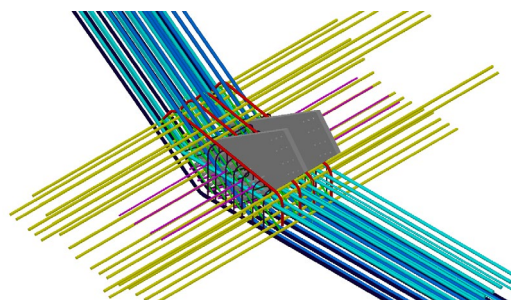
Detalle de la pieza prefabricada de conexión del delta frame (*precast shoe*)
